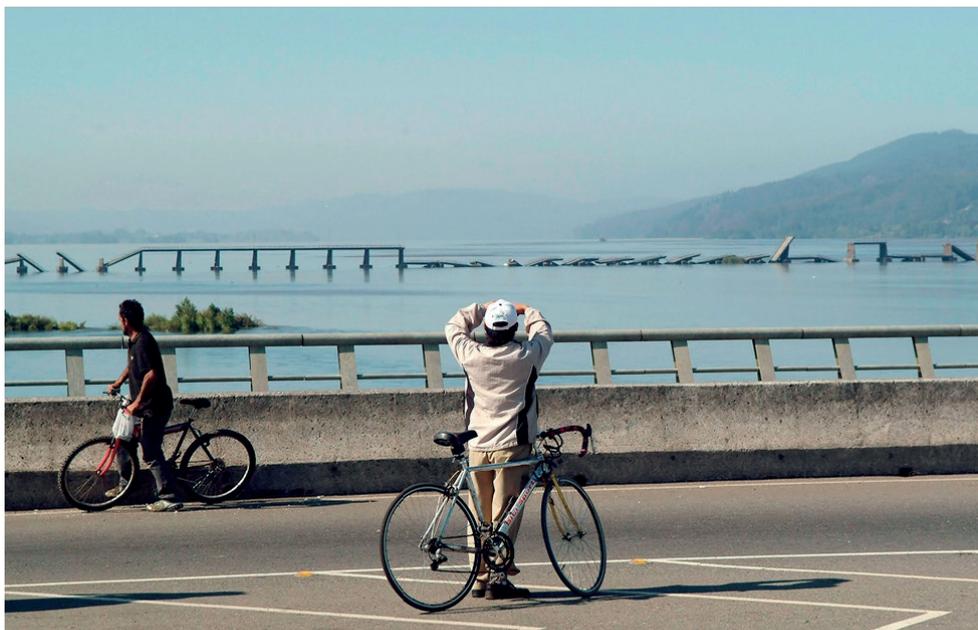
Exemple d'effondrement d'un pont suite à la liquéfaction du sol porteur (Chili 2010)
